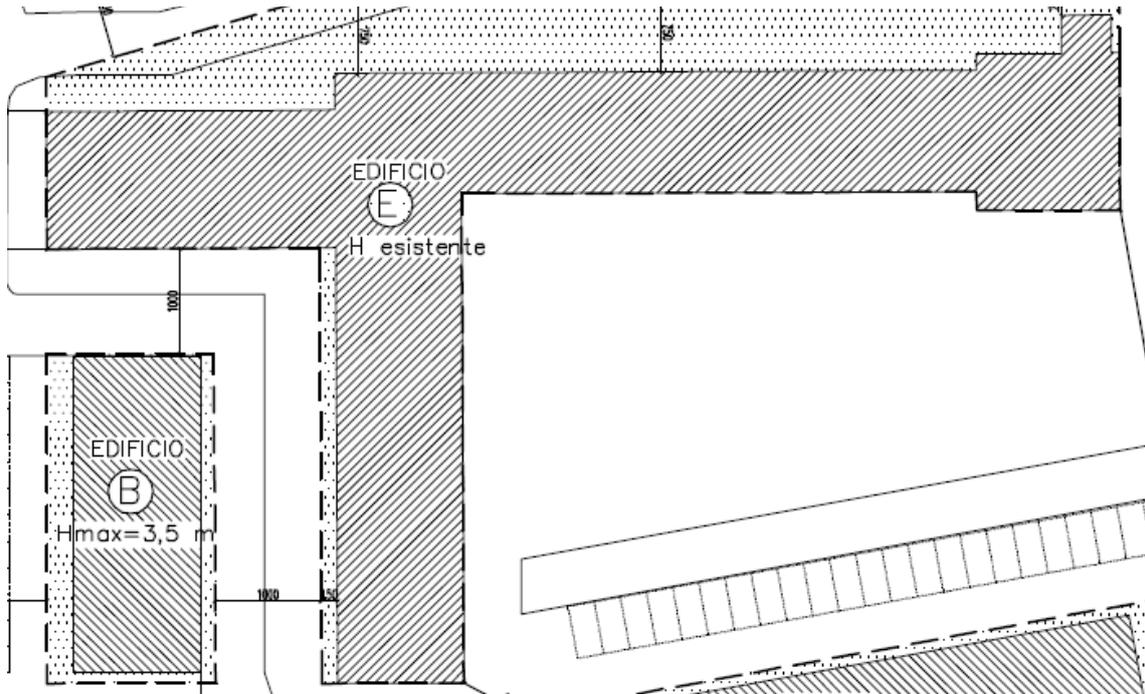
Planimetria del Piano Particolareggiato in esame.
